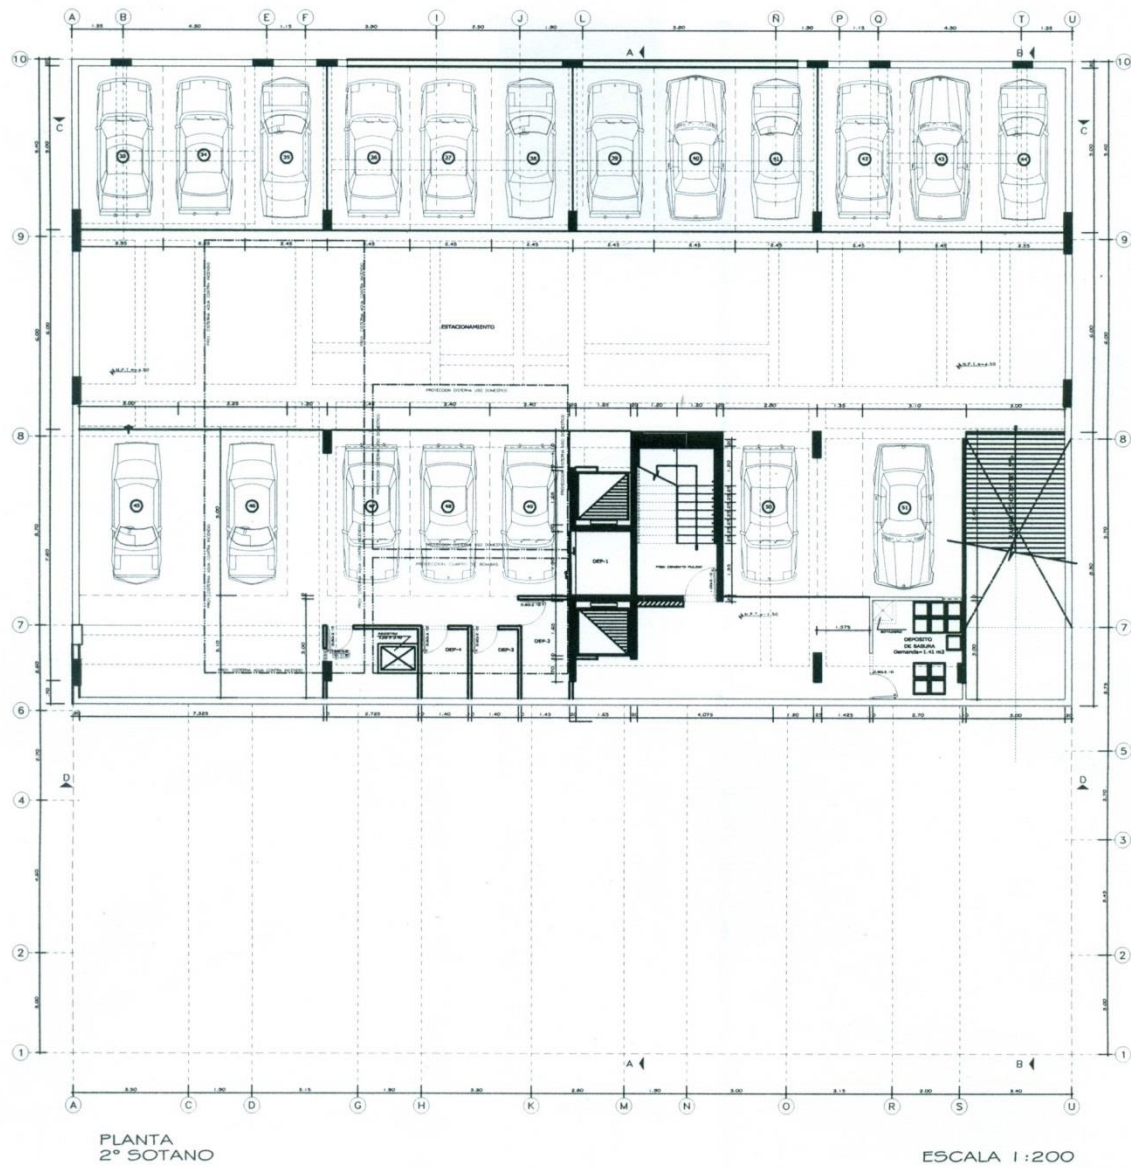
Plano de planta del sótano 2 –sótano extra- Edificio Asturias
